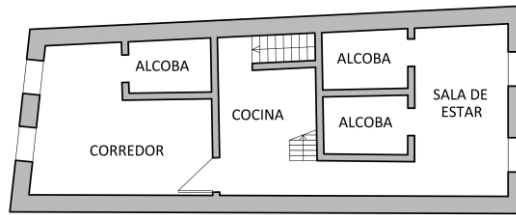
Ejemplo de distribución interior de planta primera en vivienda de entramado de madera (elaboración propia).
